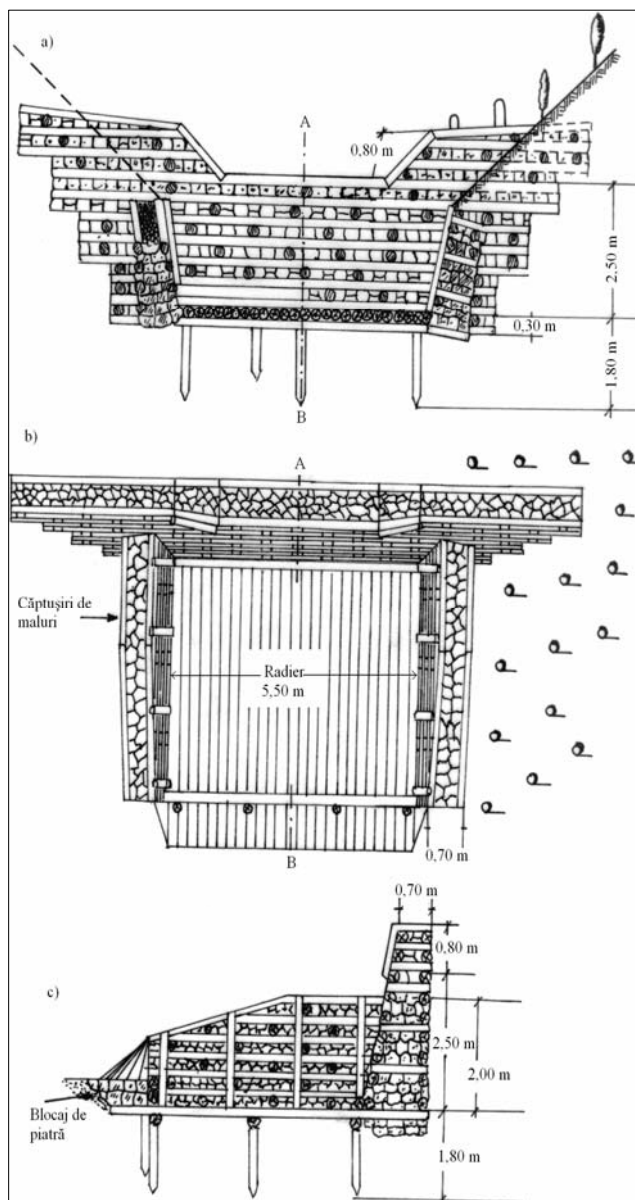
Baraj de lemn: a) vedere în profil; b) în plan; c) în secțiune.
